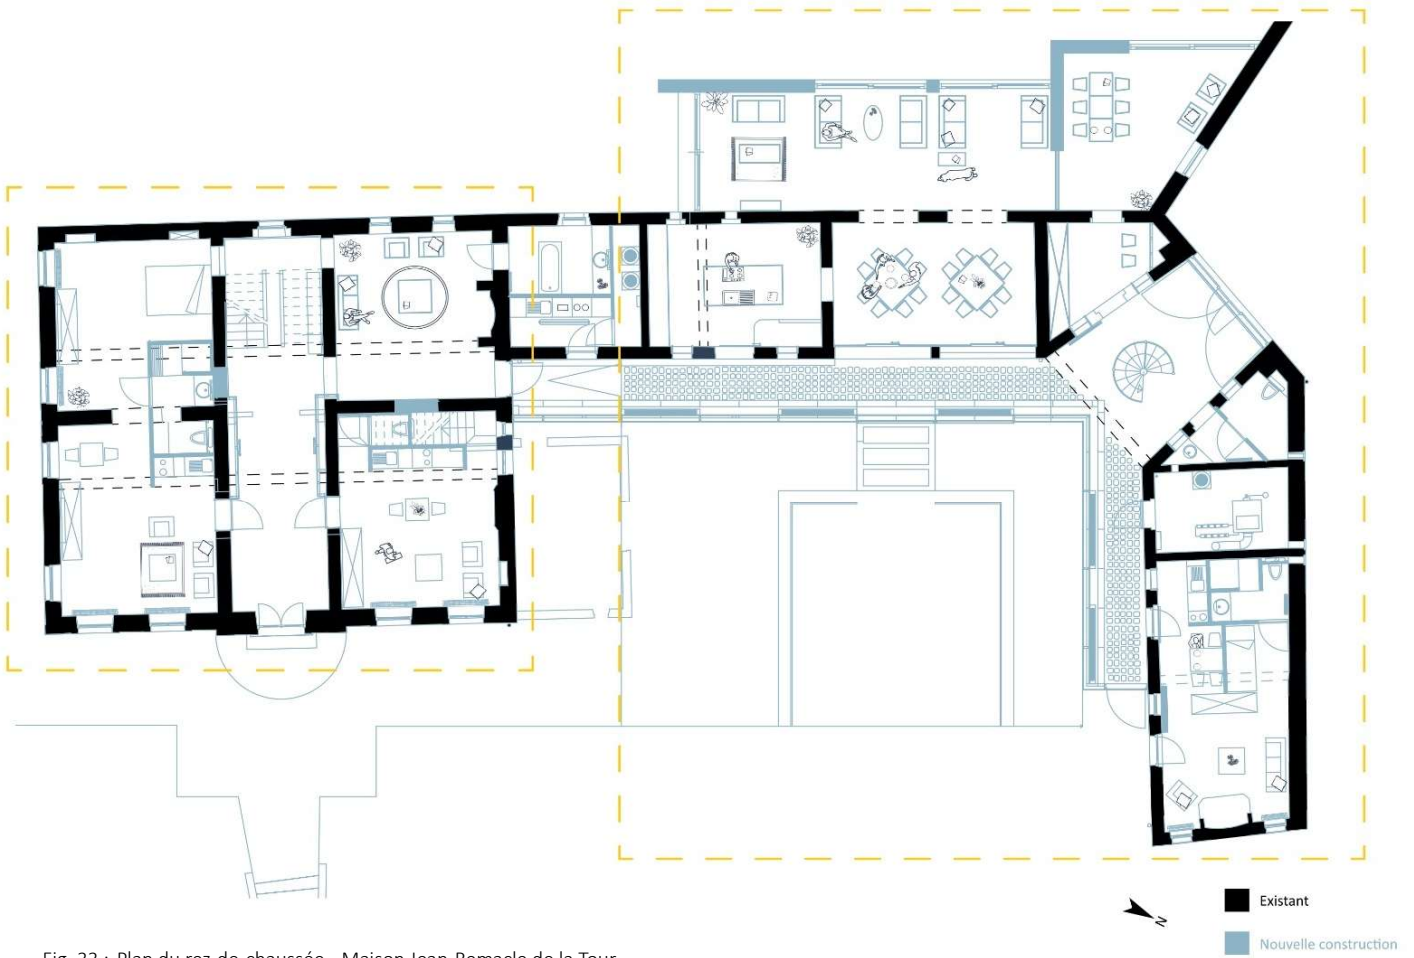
Plan du rez-de-chaussée - Maison Jean-Remacle de la Tour
